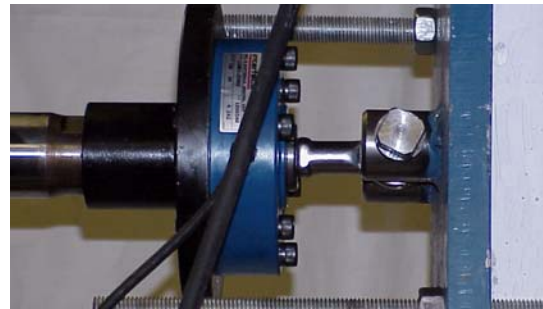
Sistema rotulado aplicado entre o actuador e a cabeça do provete.
